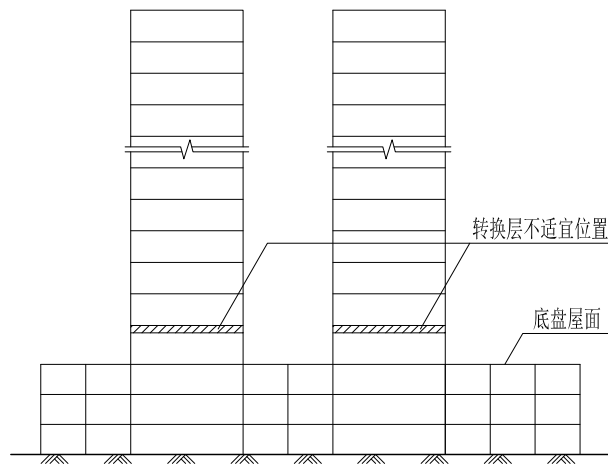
多塔楼结构转换层不适宜位置示意
